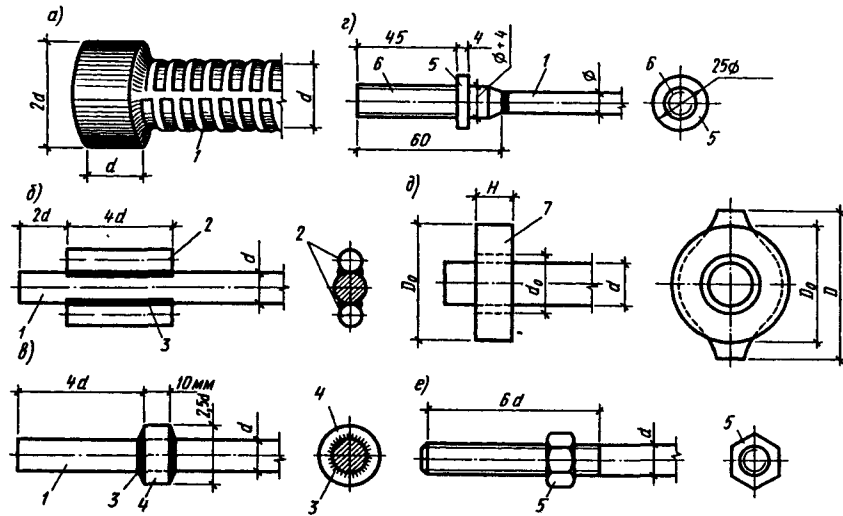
Анкерные приспособления: а) высаженная головка; б) приварка коротышей; в) приварка кольца; г) нарезной наконечник с гайкой; д) обжатая шайба; е) нарезной конец с гайкой; 1 — арматурный стержни; 2 — коротыши; 3 — сварочный шов; 4 — кольцо; 5 — гайка; 6 — стальной штампованный наконечник с нарезкой, привариваемый к арматуре; 7 — обжатая шайба.
